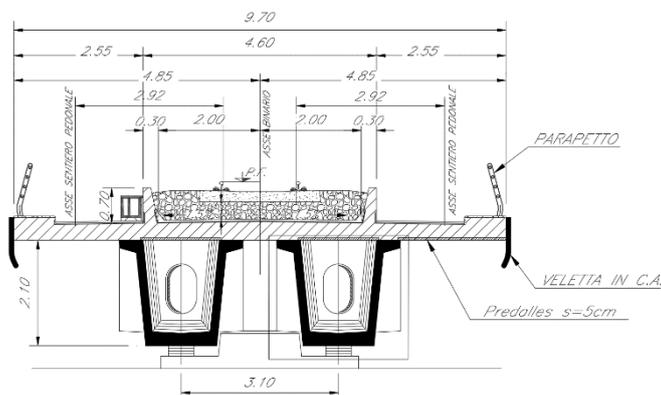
Sezione c.a.p. da 25m Singolo Binario
